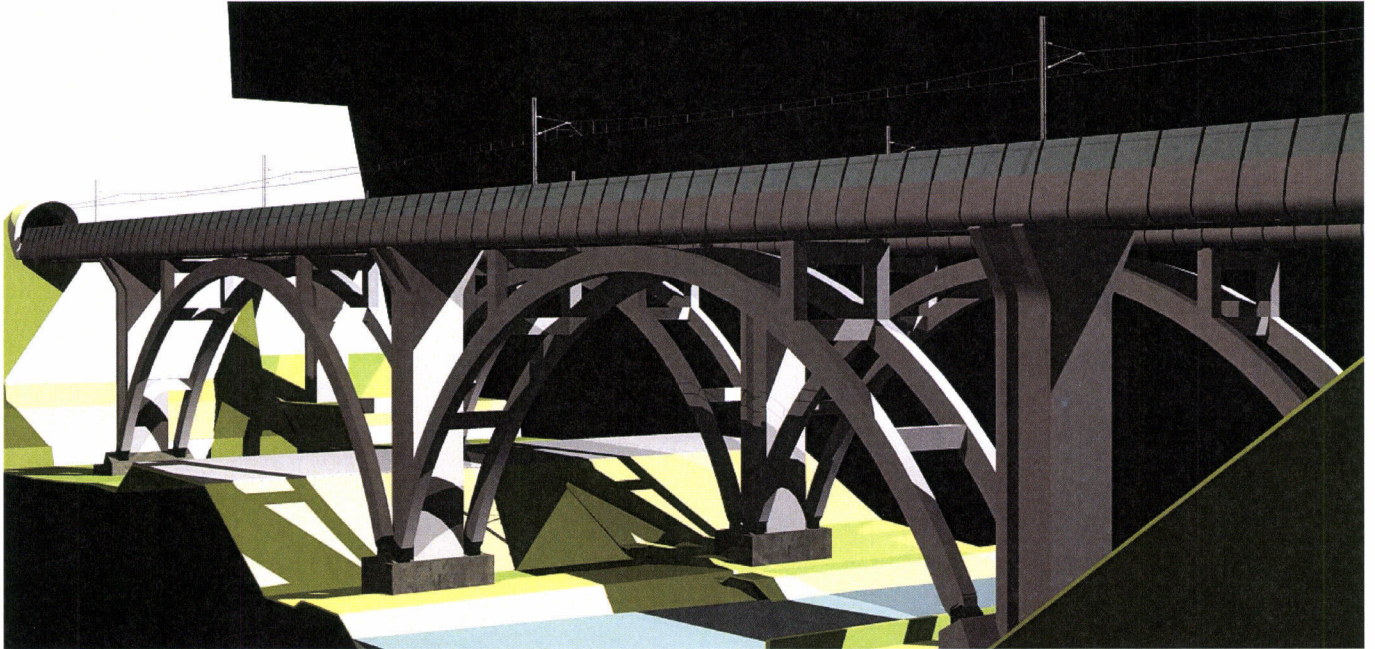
Soluzione prevista nell'attuale livello di progettazione
